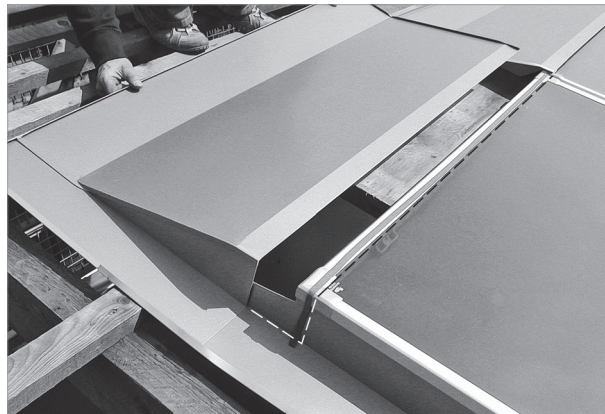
Poser la tôle supérieure sur la tôle latérale et la pousser contre le capteur
